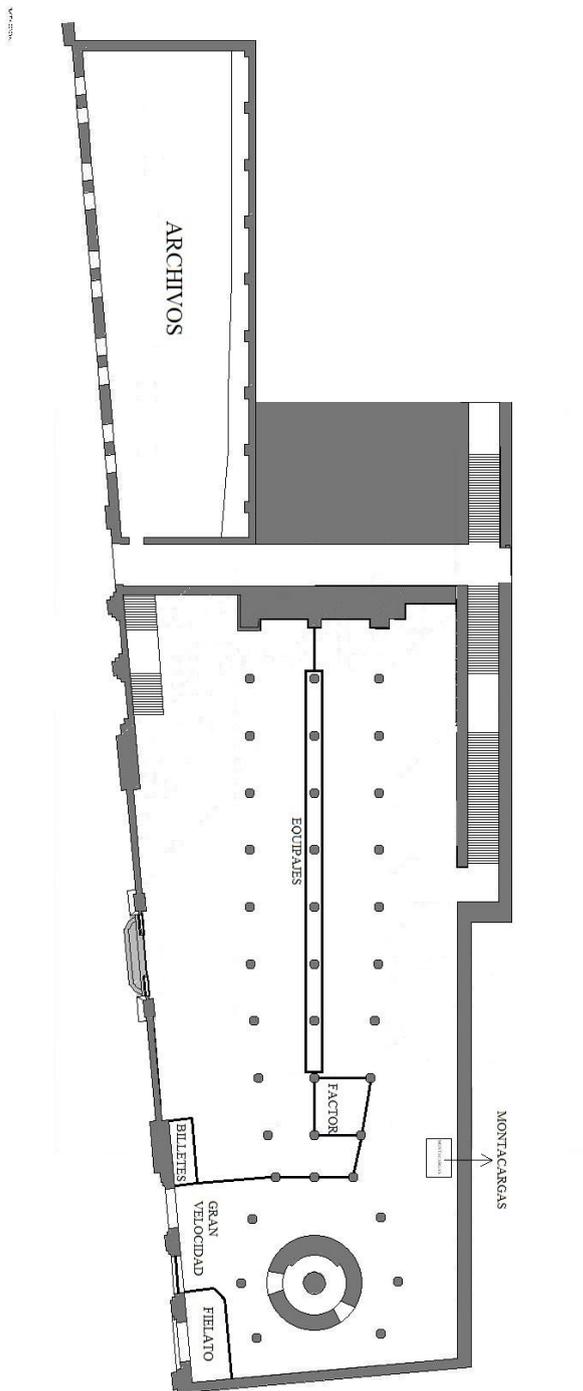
Restitución hipotética de la planta del vestíbulo en 1902. Elaboración propia a partir de un plano modificado de IMB arquitectos.
